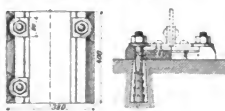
Verbindung der Auflagerplatten mit dem Auflagerstein durch Steinschrauben. M. 1 : 20.
